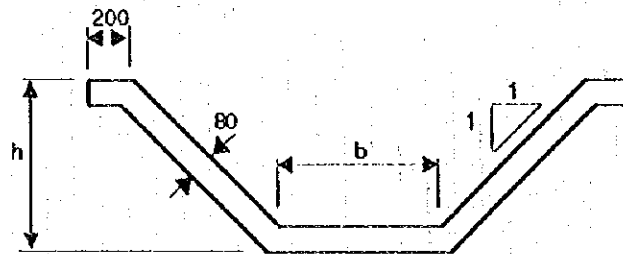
Section standard des canaux d'irrigation principaux
